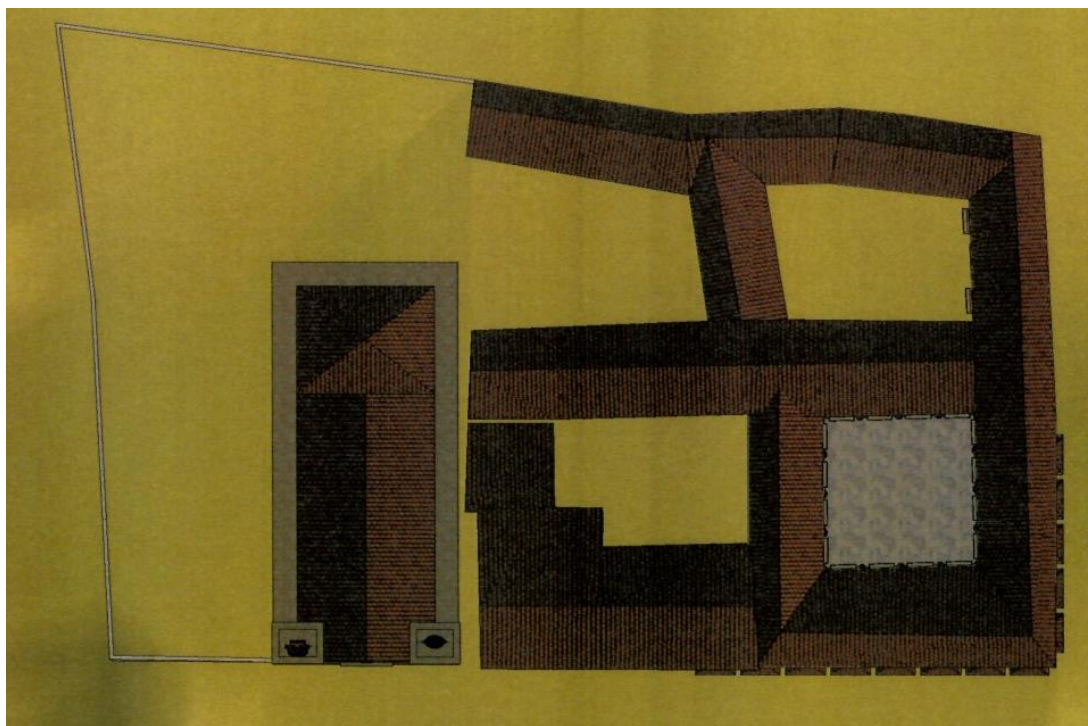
Reconstrucción virtual de la planta de cubiertas. Elaboración propia.
